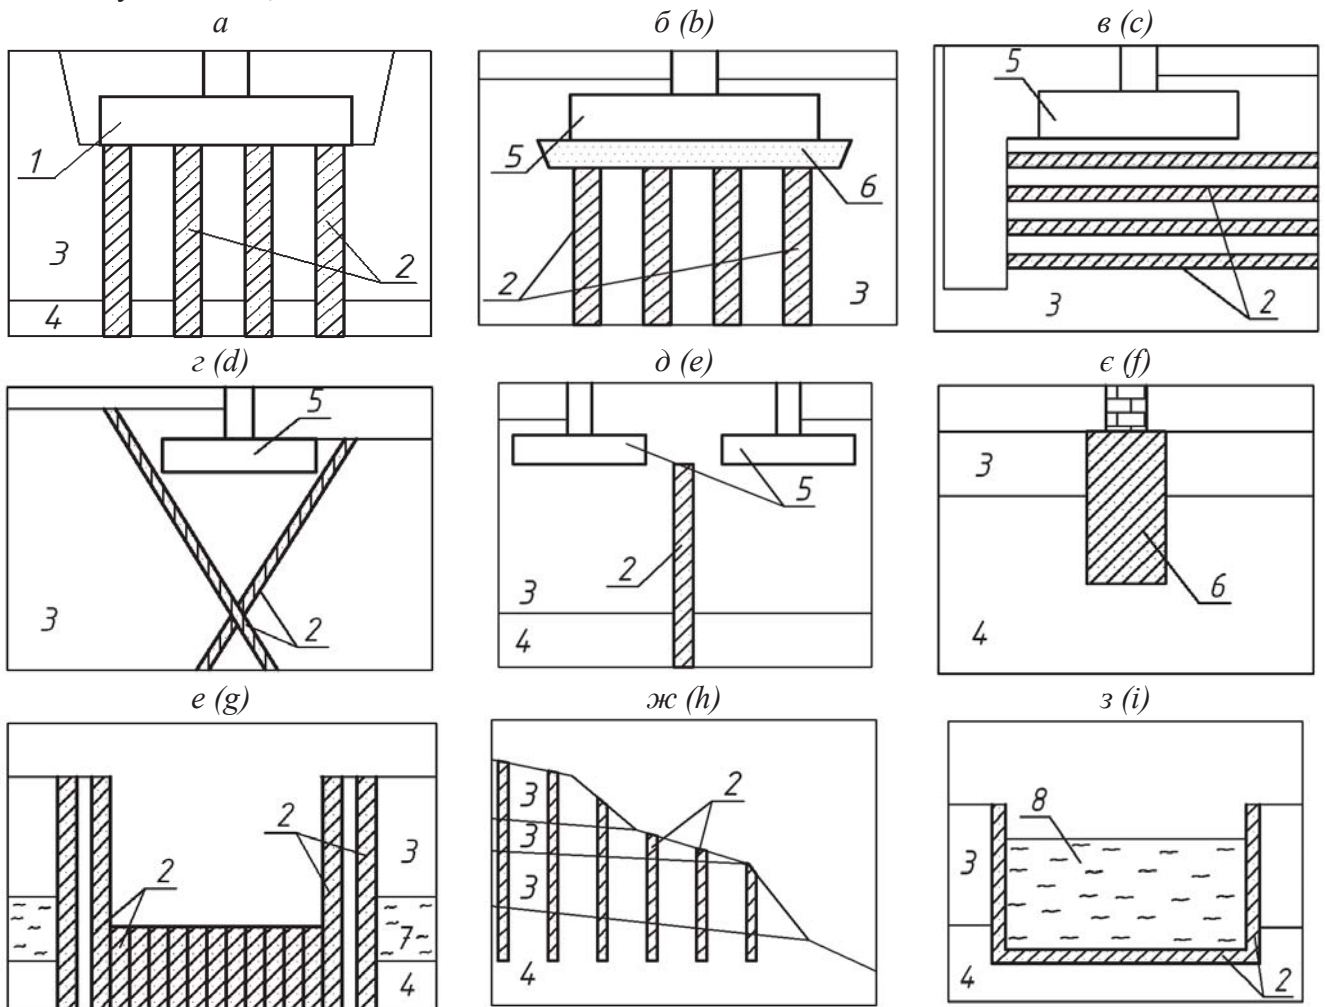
Використання ґрунтоцементу в геотехніці: а, б – пальові фундаменти; підсилення існуючих фундаментів: вертикальними ГЦЕ; в – горизонтальними ГЦЕ; г – похилими ГЦЕ; д – улаштування роздільних екранів; е – улаштування фундаментів мілко закладення під малоповерхові будівлі; г – закріплення укосів котловану і захист від ґрунтових вод; ж – закріплення нестійких укосів і схилів; з – улаштування резервуарів: 1 – ростверк; 2 – ґрунтоцементні елементи; 3 – слабкий ґрунт; 4 – міцний ґрунт; 5 – фундамент; 6 – стрічковий фундамент з ґрунтоцементу; 7 – водонасичений ґрунт; 8 – рідина резервуарів / Fig. 1. The using of soil cement in geotechnics: a, b – pile foundations; enhancement of existing foundations: vertical SCE; c – horizontal SCE; d – inclined SCE; e – arrangement of separate screens; f – arrangement of foundations of shallow laying under low-rise buildings; g – fixing of slopes of a pit and protection from ground waters; h – fixing unstable slopes and slopes; i – arrangement of reservoirs: 1 – rafters; 2 – ground cement elements; 3 – weak soil; 4 – strong soil; 5 – the foundation; 6 – tape foundation from the soil cement; 7 – water-saturated soil; 8 – liquid reservoirs
